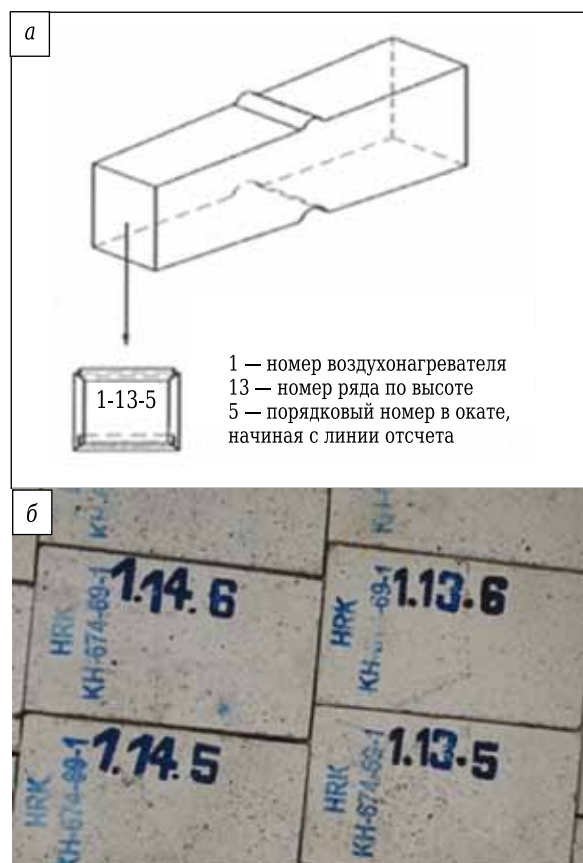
Маркировка изделий на примере купола формеры: а — порядок идентификации; б — внешний вид изделий
